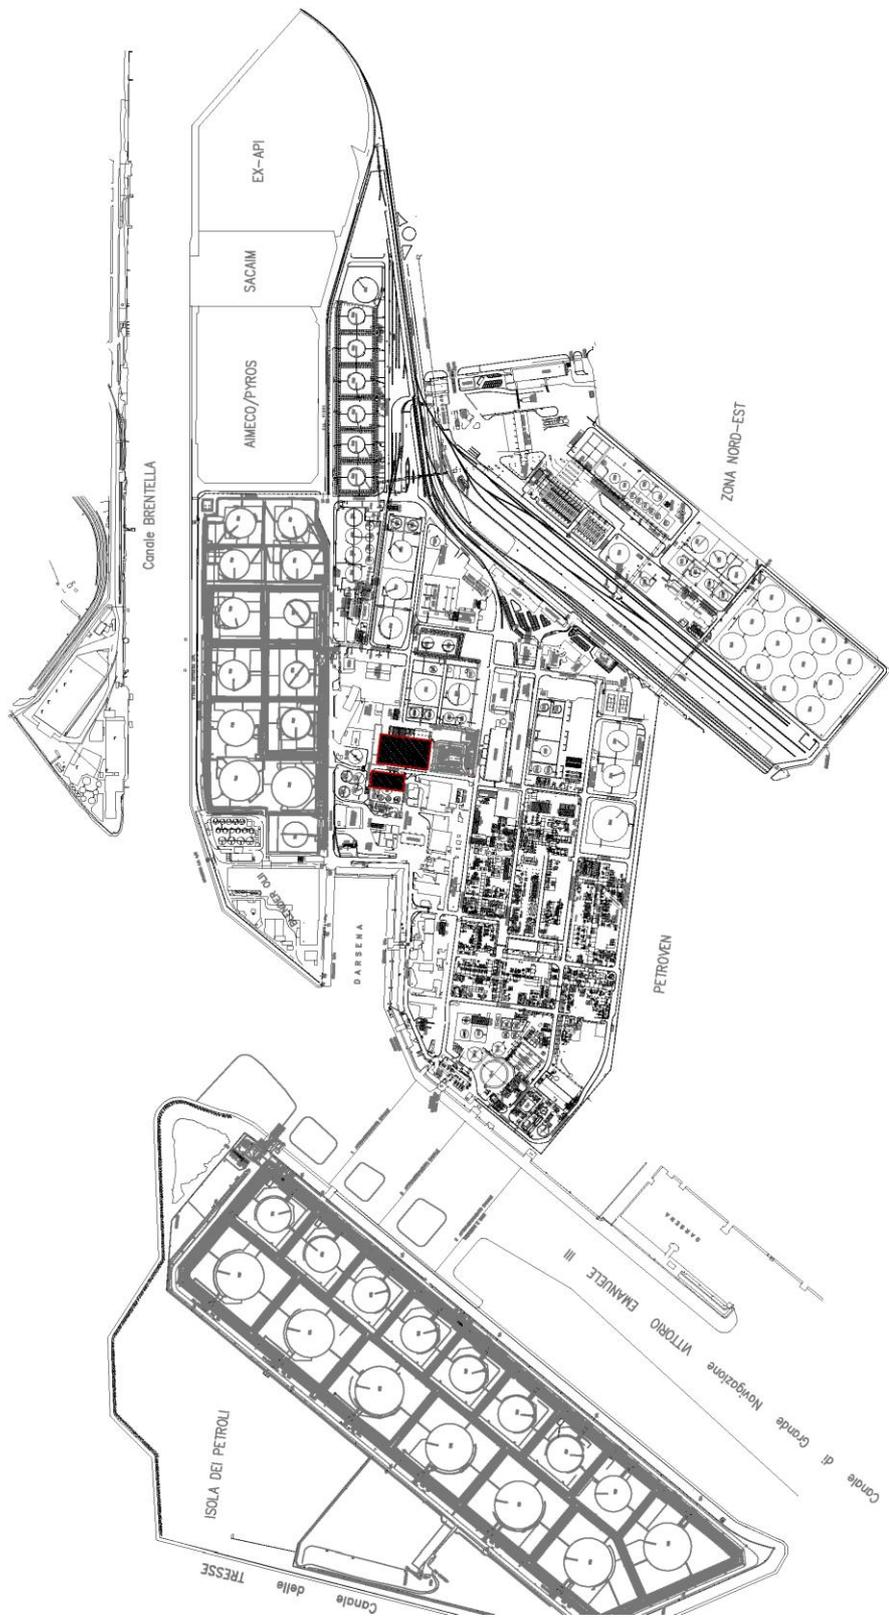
Planimetria generale con individuazione delle nuove aree di impianto
